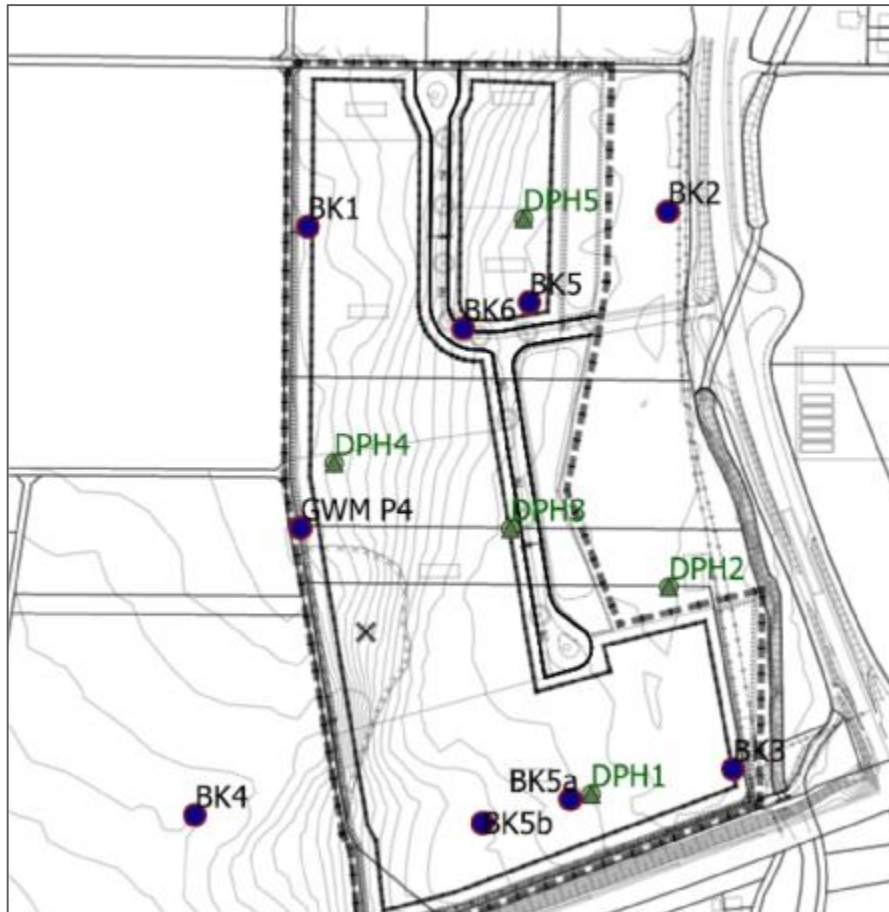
Lage der Geotechnischen Aufschlüsse (Plangrundlage: PlanWerkstatt, Bodensee)
